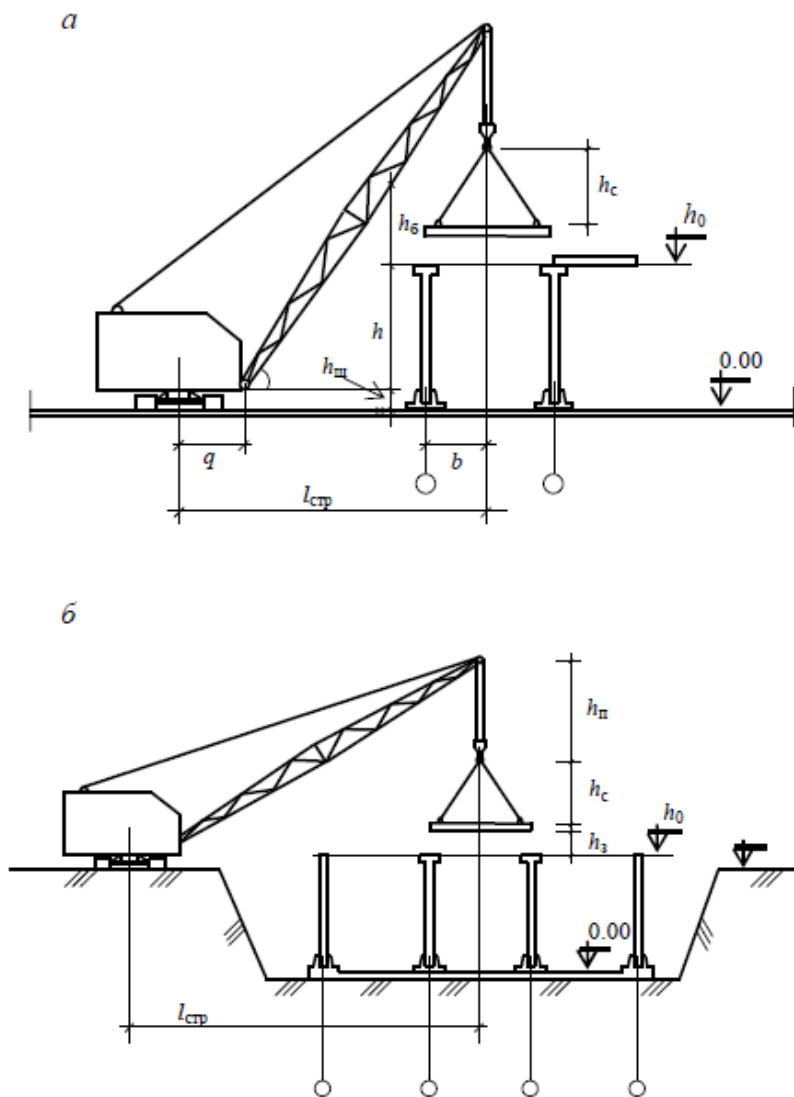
Схемы для определения требуемых параметров кранов при укладке плит покрытия с дна сооружения (а) и с бермы котлована (б)
